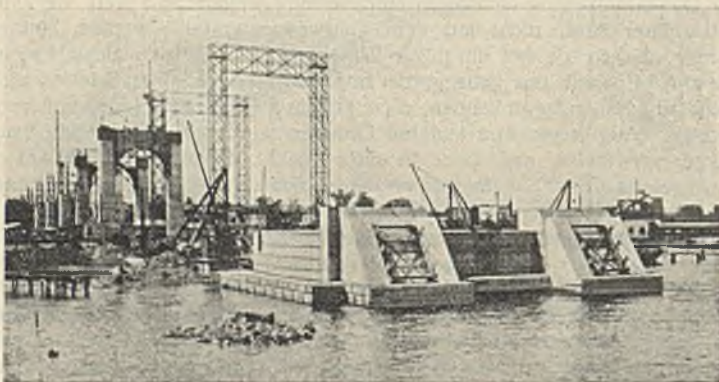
Widerlager der Hauptöffnung fertig zur Aufstellung des Bogens (Richmond, August 1929).
